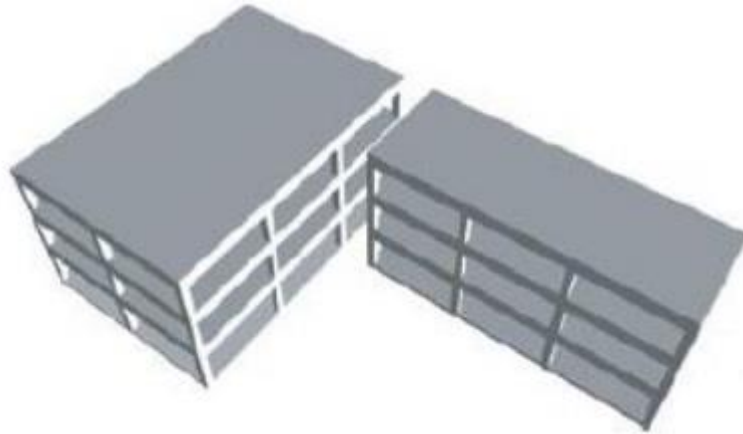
Separação de uma configuração em planta em L (FEMA 454)
